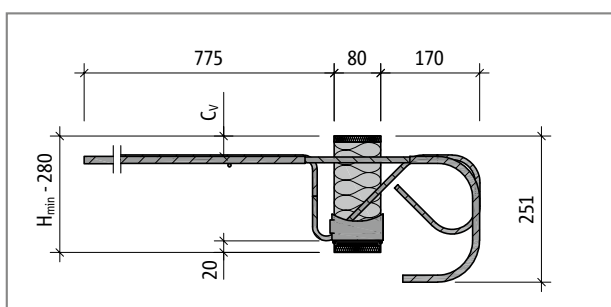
Schöck Isokorb® T tipo KL-O-M8 - KL-O-M12: Sezione dell'elemento
